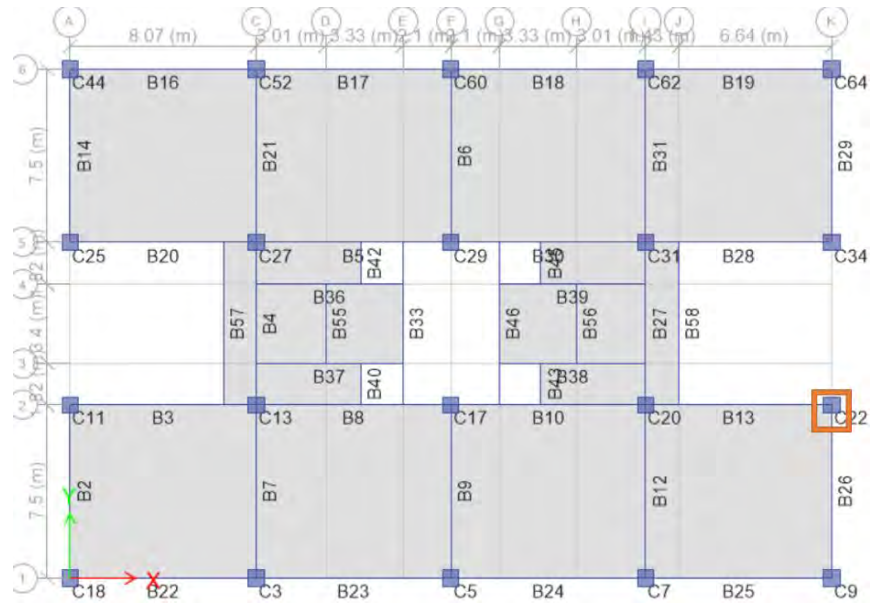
Ubicación de la rótula más girada para la viga (piso 3) y columna (piso 1) en dirección Y-Y.
